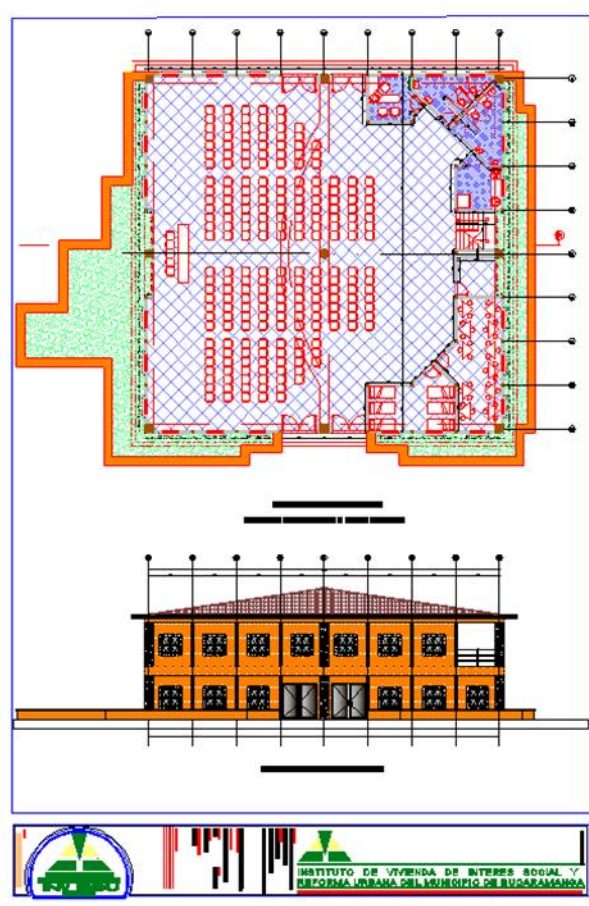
Salón social, planta primer piso y fachada principal. Fuente el Autor.
